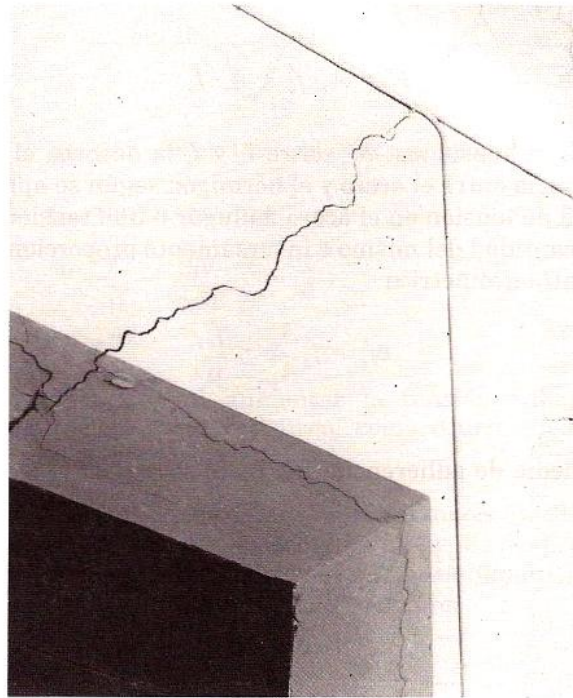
Viga dintel fisurada por torsión
